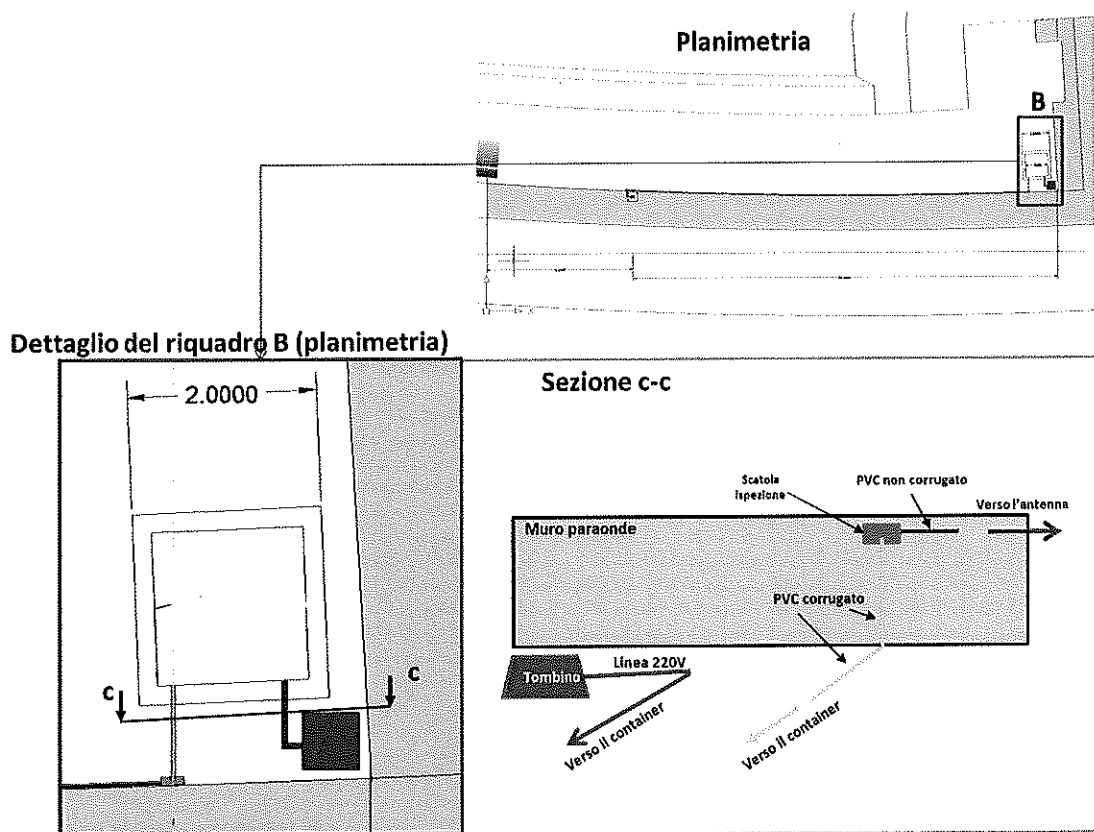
Dettaglio possibile collegamento dati ed elettrico al sito di installazione dello shelter.
